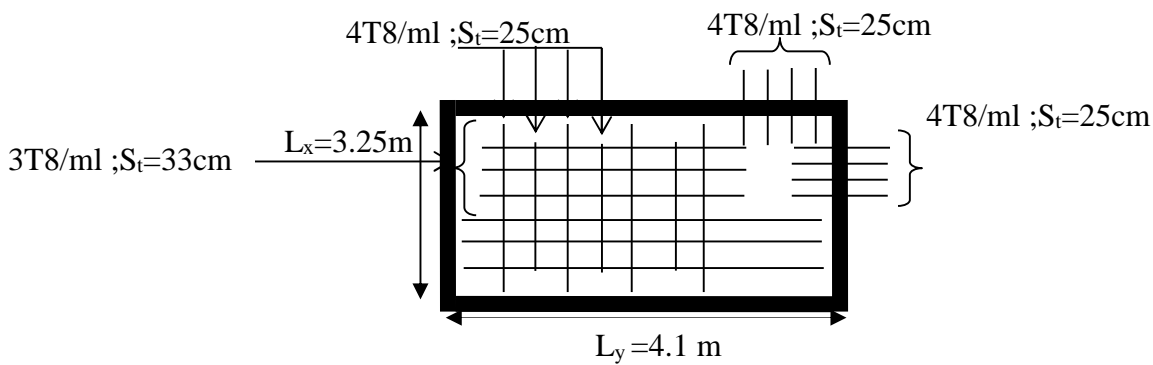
Schéma de ferraillage Dalle pleine sur quatre appuis
